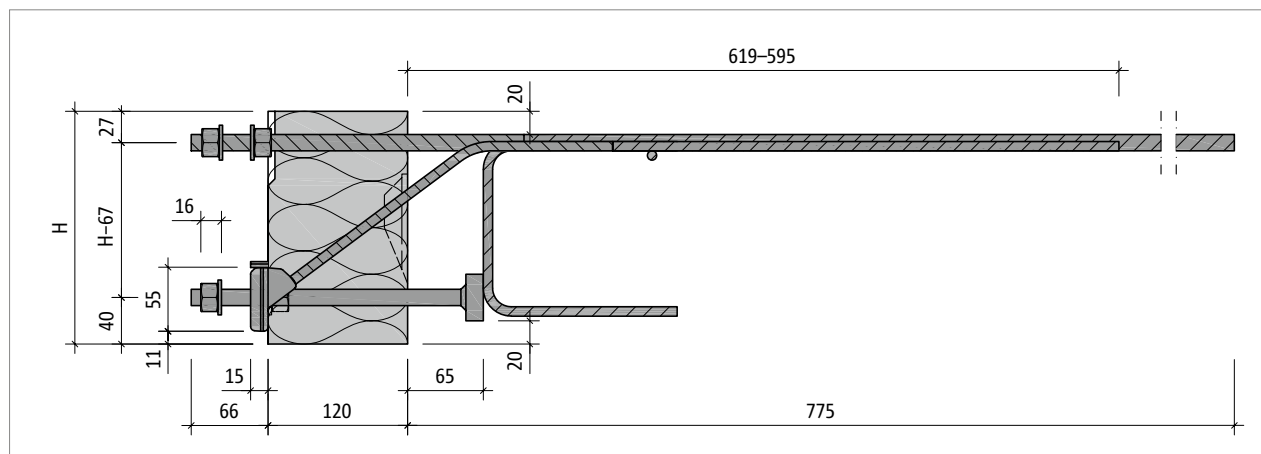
Schöck Isokorb® XT type SK-M1 : vue en coupe du produit
